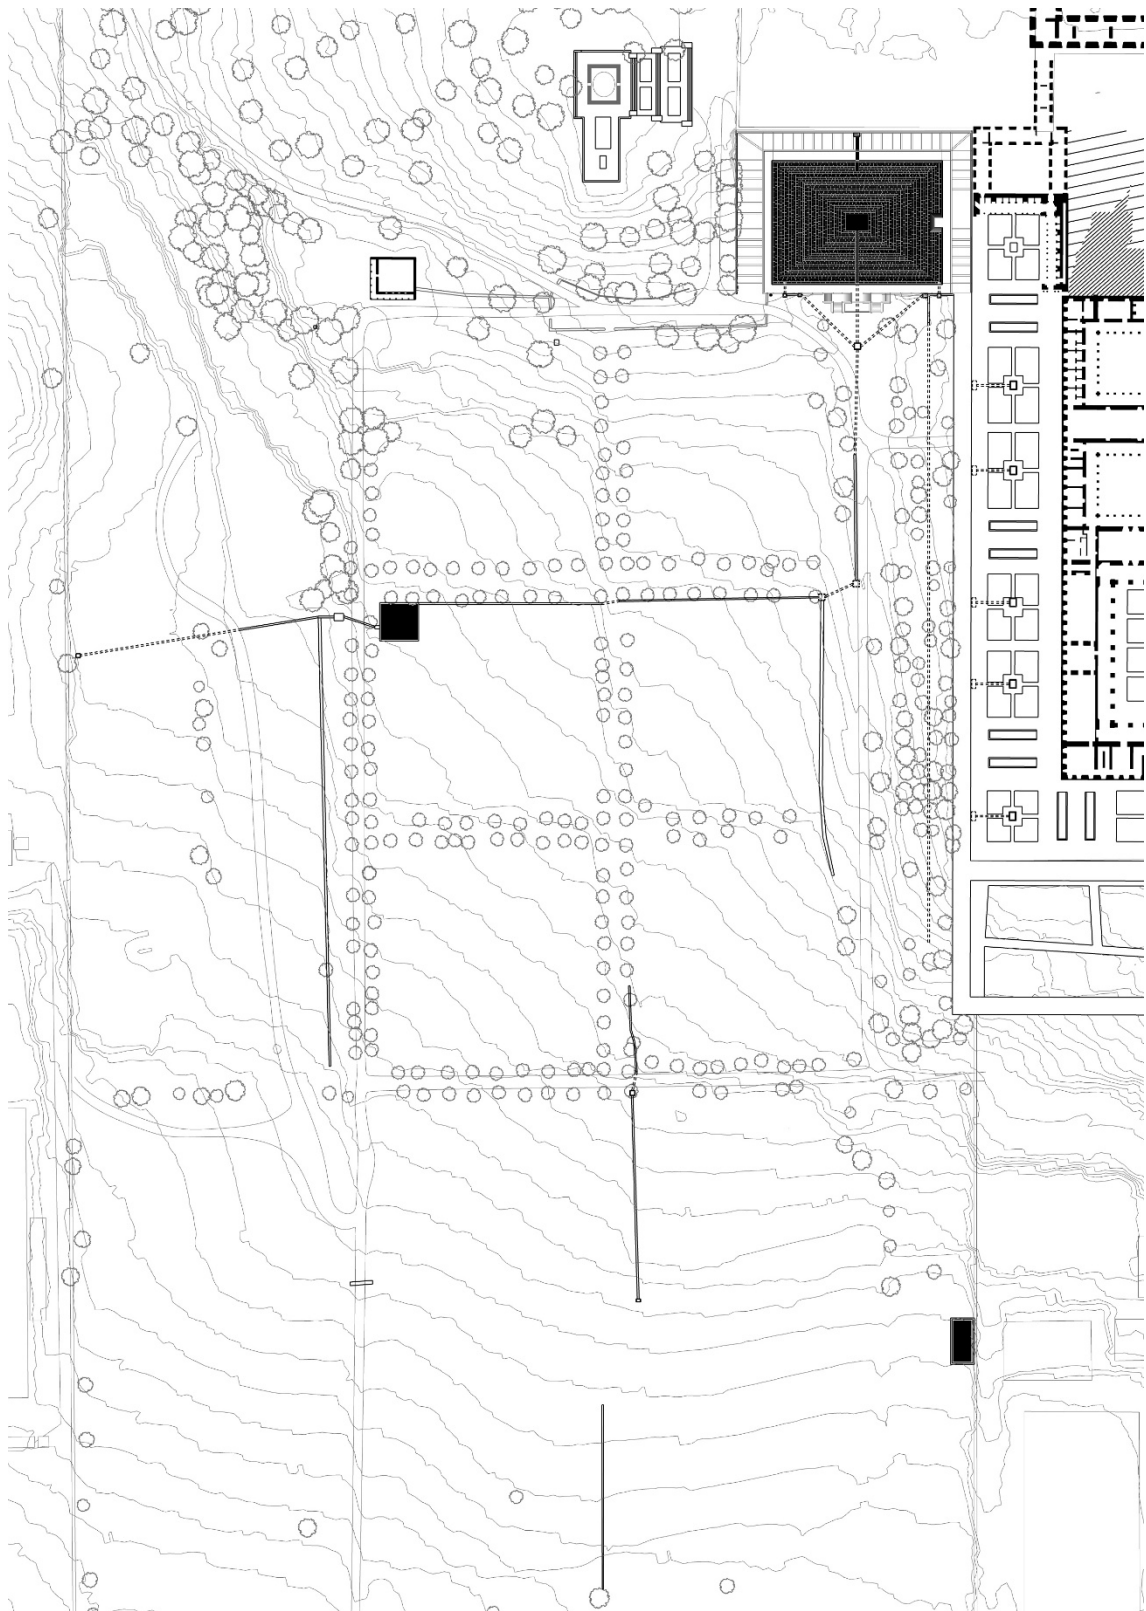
Planta general de las huertas del Monasterio levantamiento de los restos de las conducciones del sistema de riego. Elaboración propia
